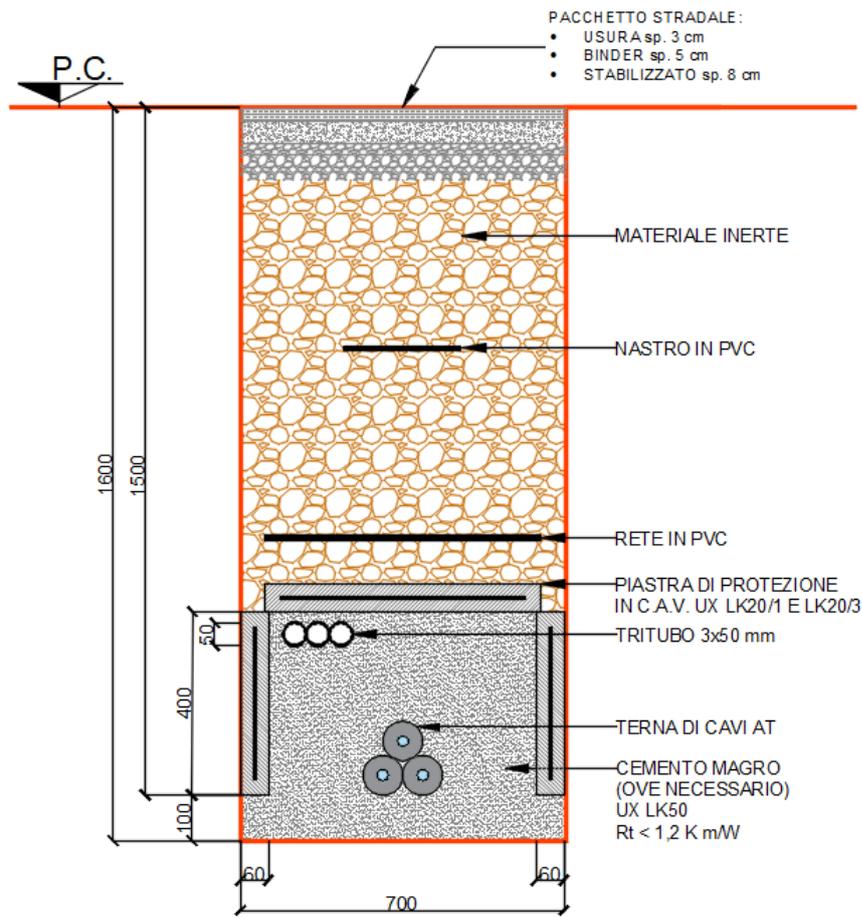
Sezione tipologica scavo e posa cavo AT
